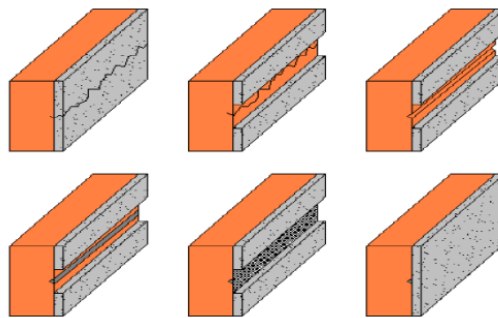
Etapas do tratamento de fissuras (28).
